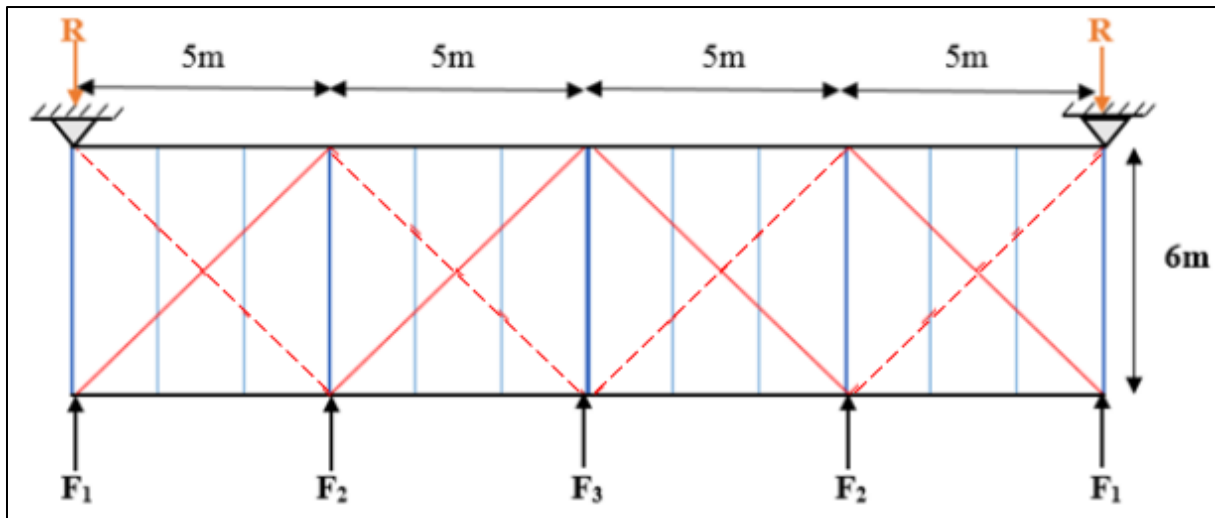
Schéma statique de la poutre au vent (effet de traction).
